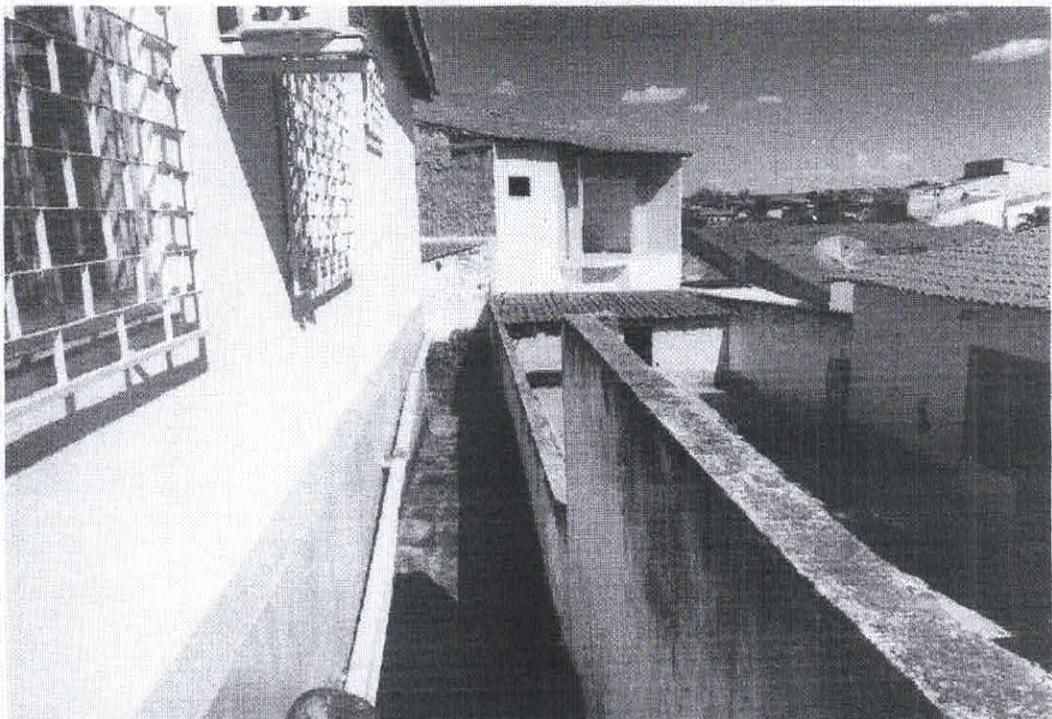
FACHADA LATERAL – DIFERENÇA MURO DE PROTEÇÃO
